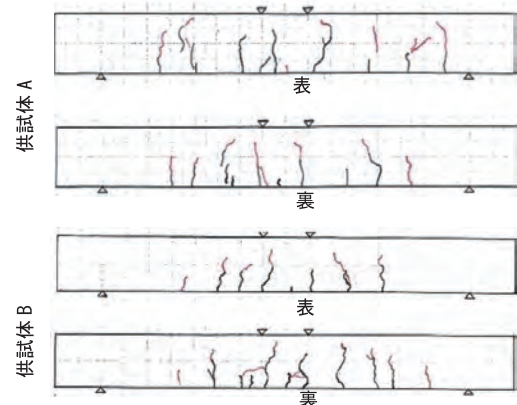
ひび割れ図(供試体AおよびB、40kN時)
